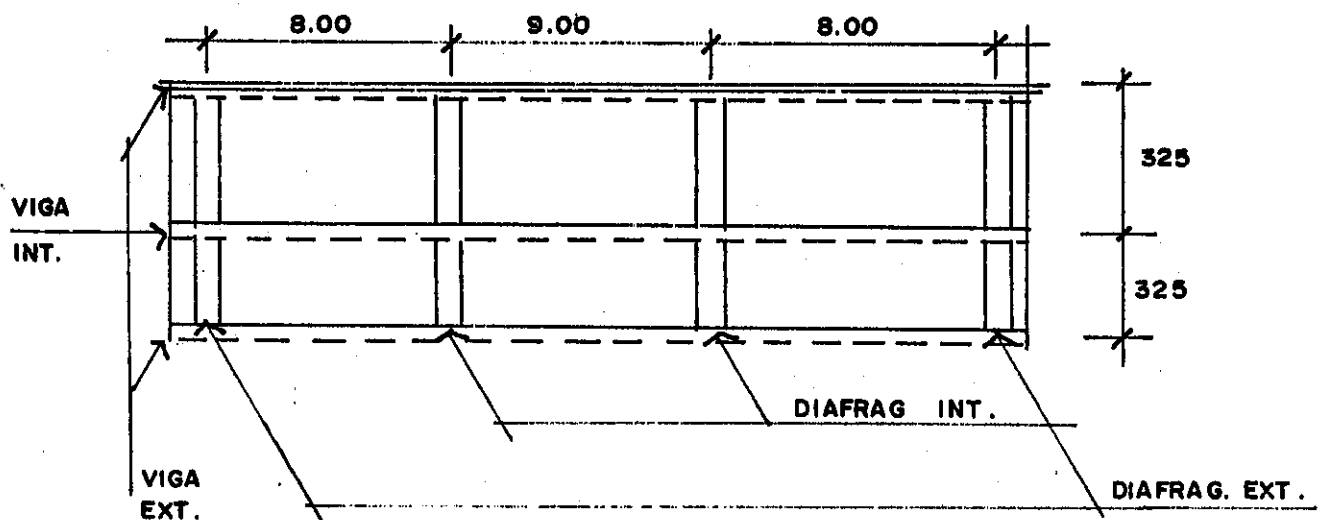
(b) SECCION LONGITUDINAL DE DIAFRAGMA
